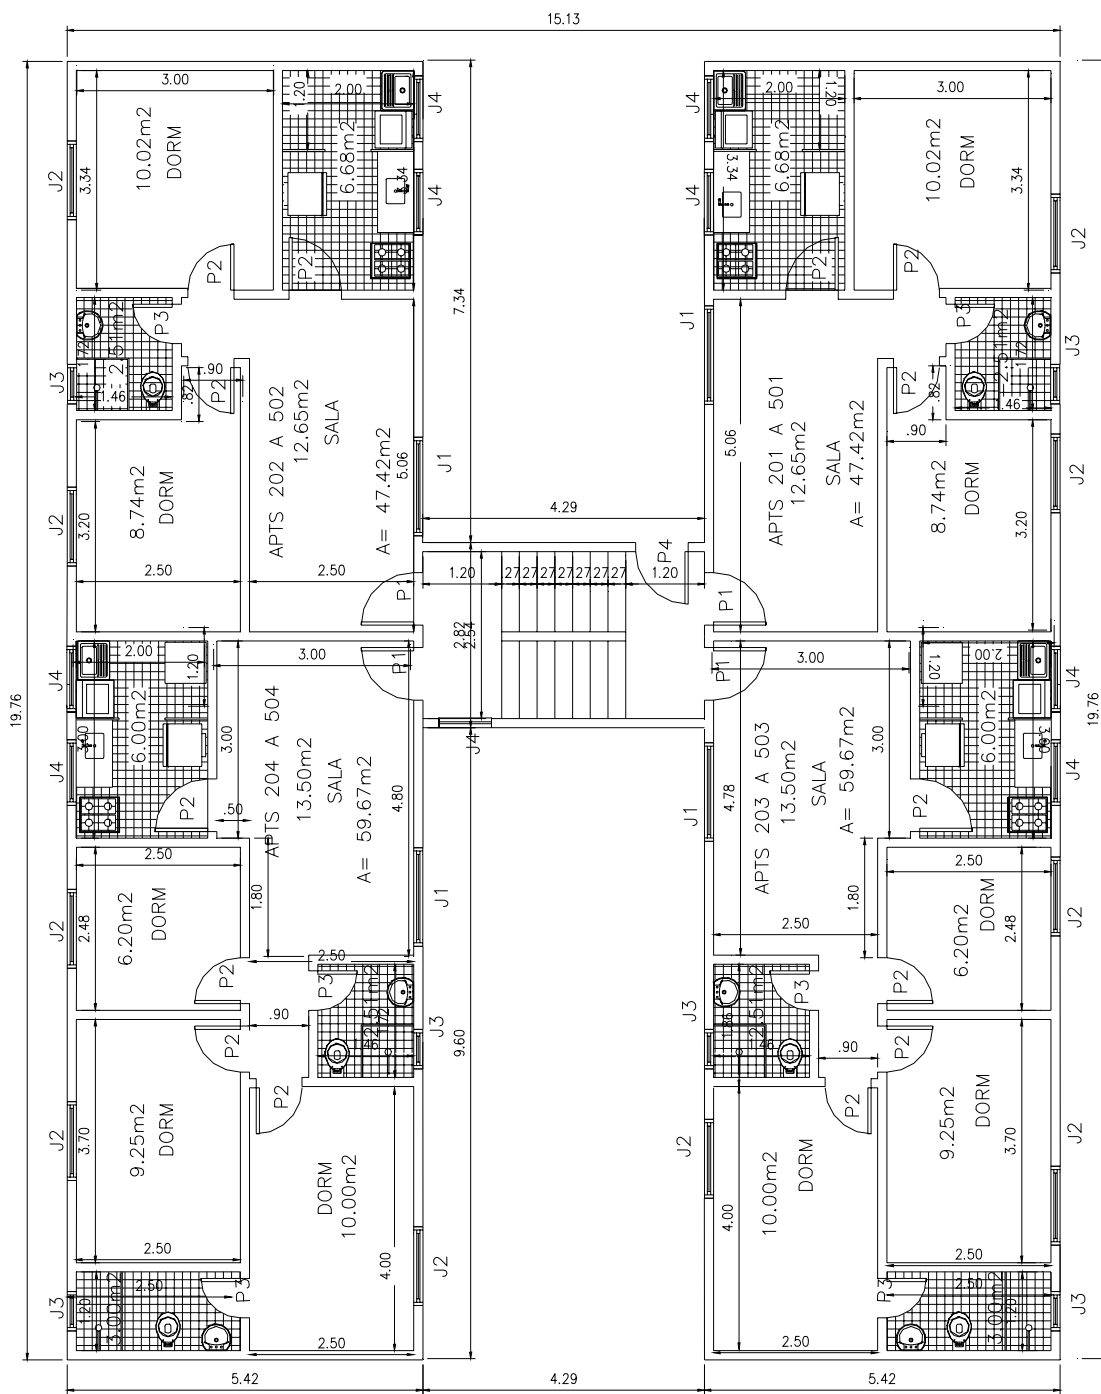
Residencial “J” – Bloco 5 – Pavimento tipo
